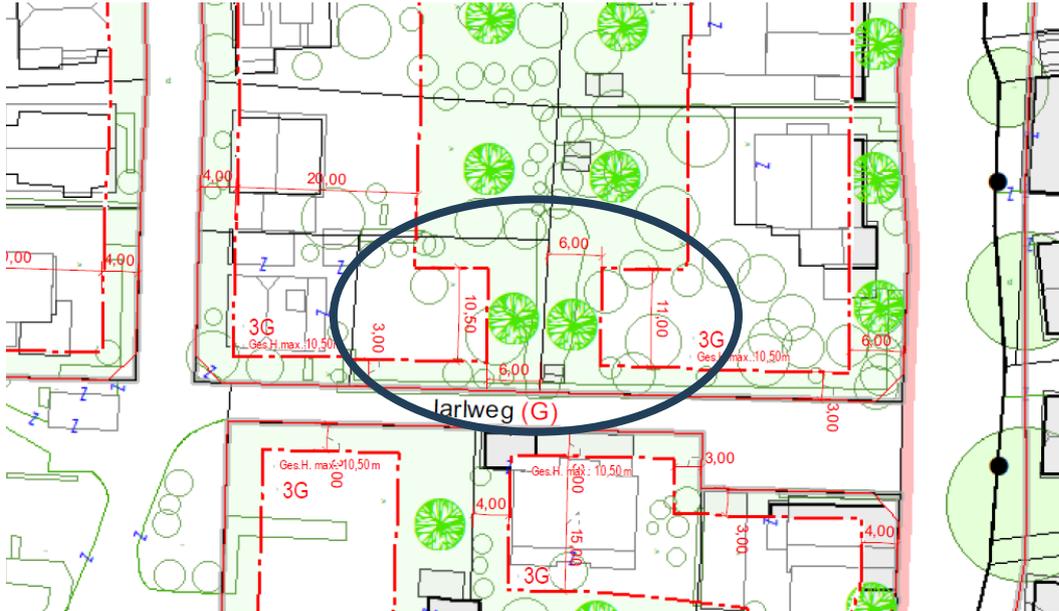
17.24.0 Bebauungsplan – Anhörung: Ausschnitt des Bereiches der Änderung
